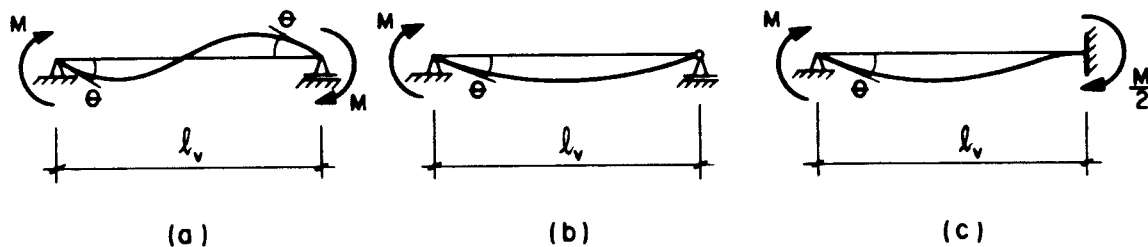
CORREÇÃO DA RIGIDEZ DA VIGA.
